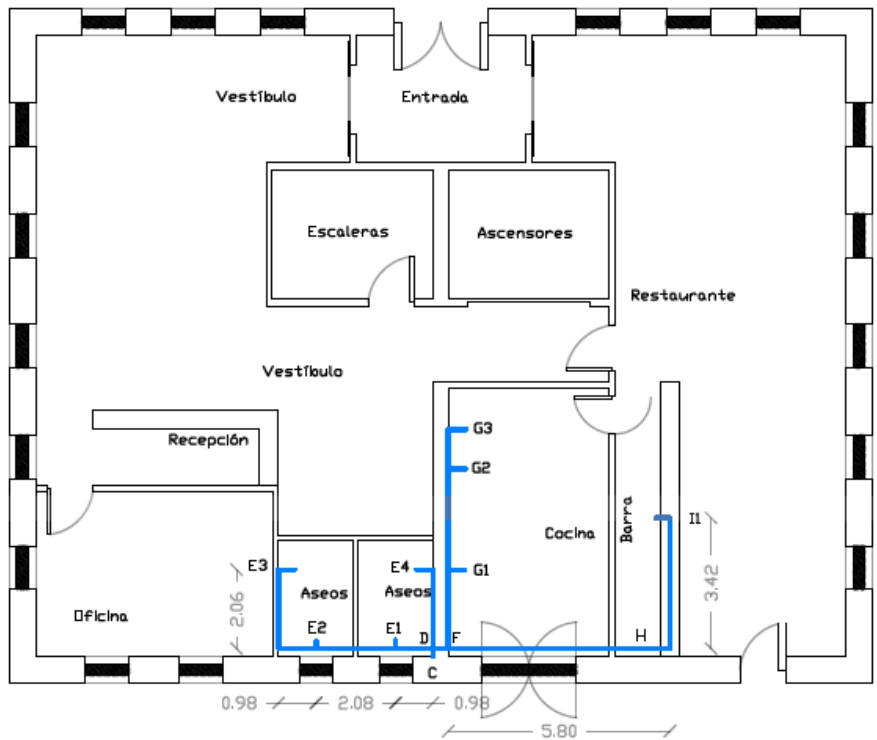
Plano de la red de suministro de agua en la planta baja. Fuente: Elaboración propia
